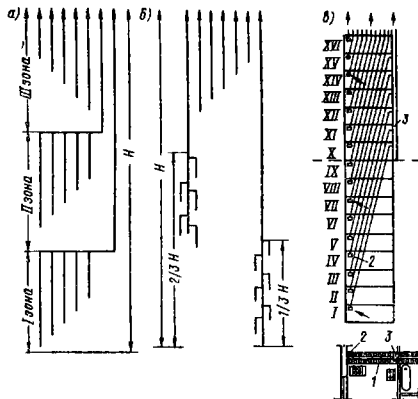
Схемы устройства вытяжных каналов для зданий в 16 этажей и более
